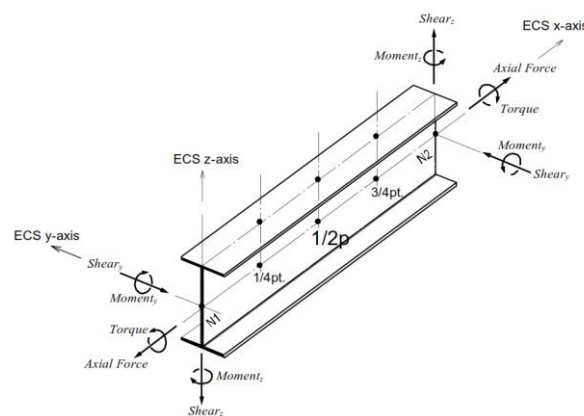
Elemento tipo viga. Fuente: MIDAS, Analysis for Structures
